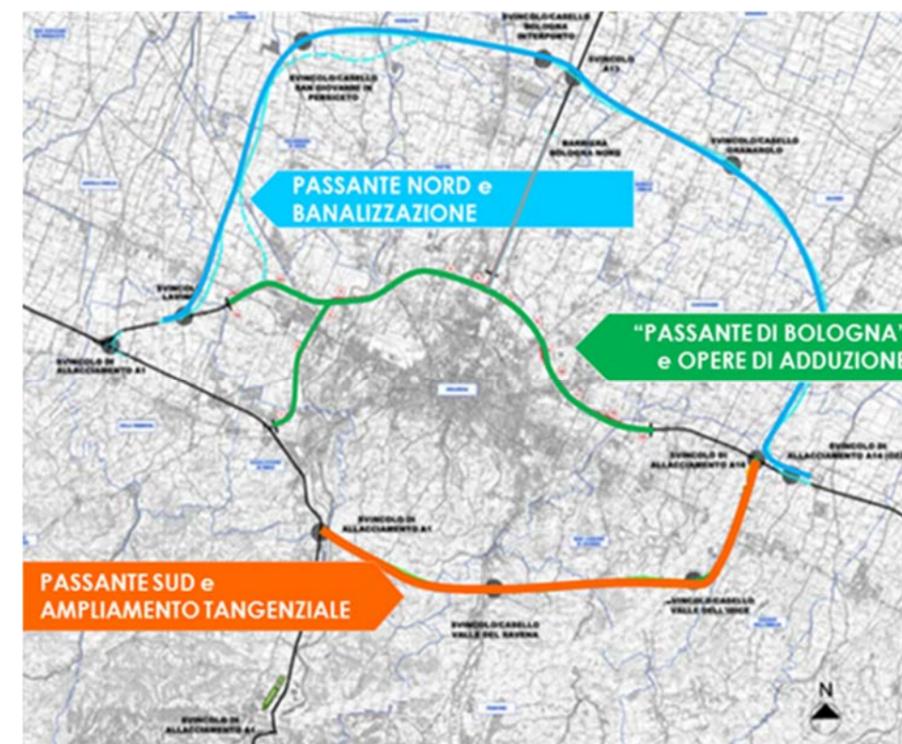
Le alternative di tracciato (fonte: *Progetto preliminare*)
